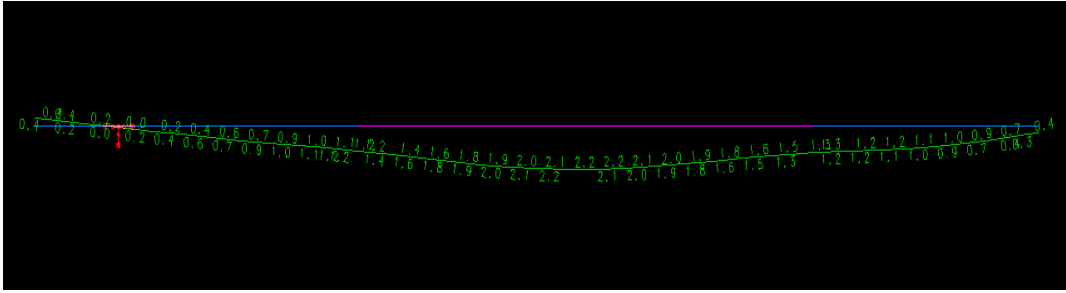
Deslocamentos verticais V5 do 1º pavimento, concreto protendido (CAD/TQS).
